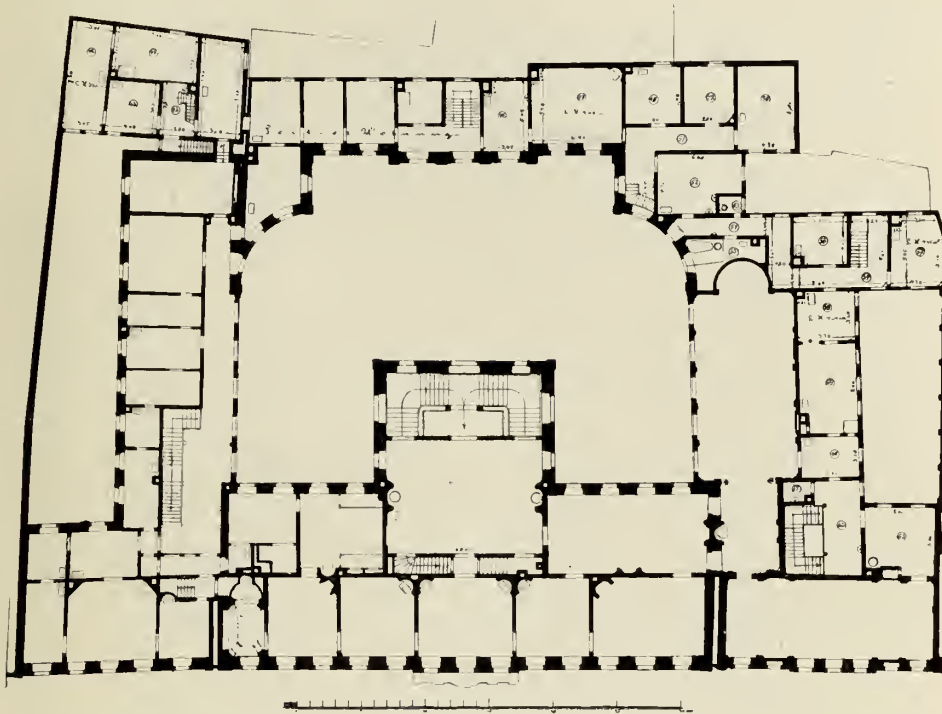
Palais an der Leinstraße. Grundriß des Obergeschosses nach der Lavesschen Planung von 1818.
